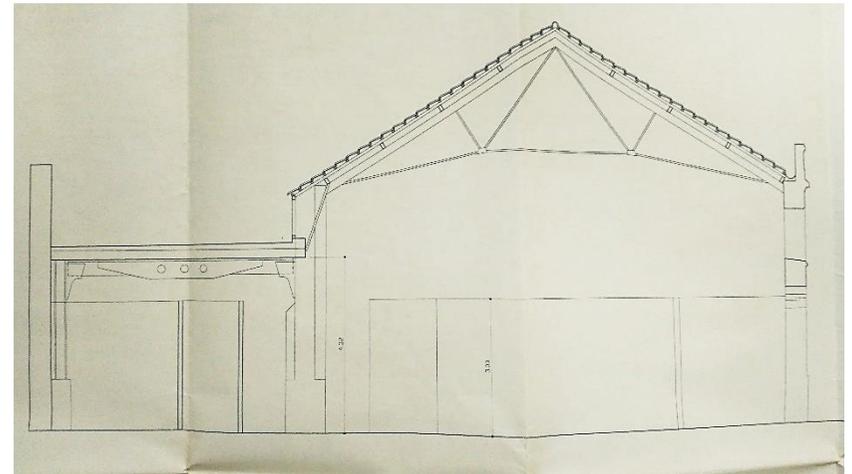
Sección transversal, aparece reemplazada la cubierta inclinada por una cubierta plana. Fuente: GMU
